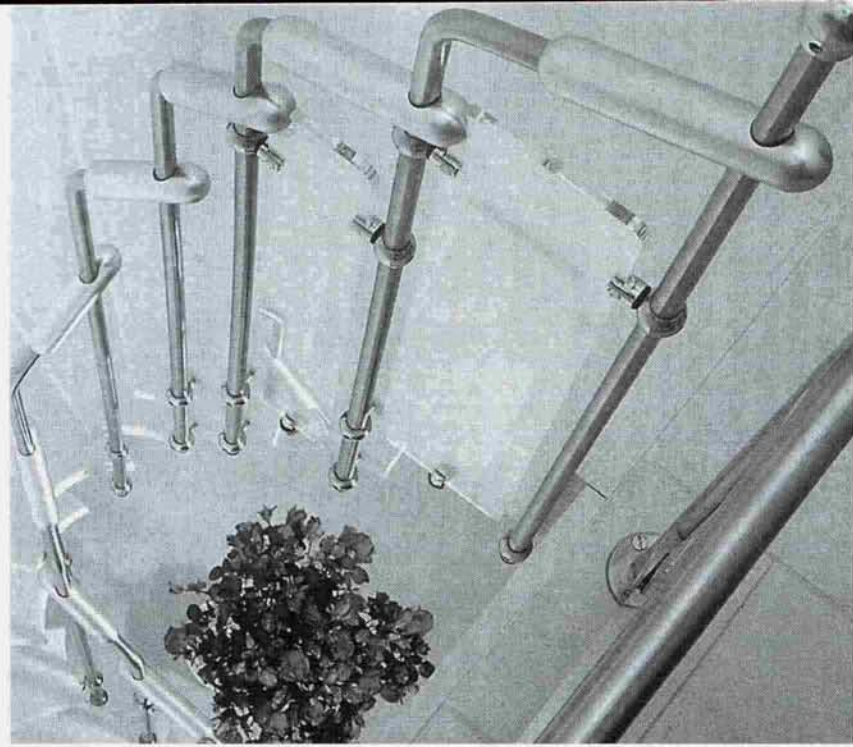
Готовый сборный каркас ограждения с прямоугольными и клиновидными деталями ступеней.
